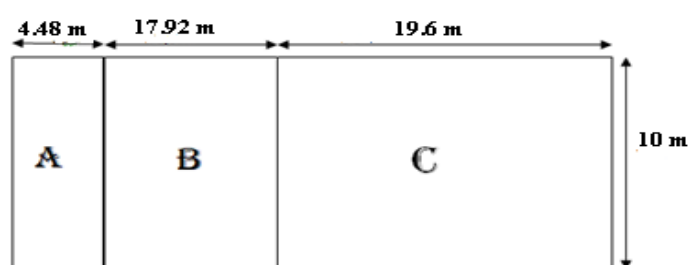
Zone de pression sur les parois verticales « long pan »
